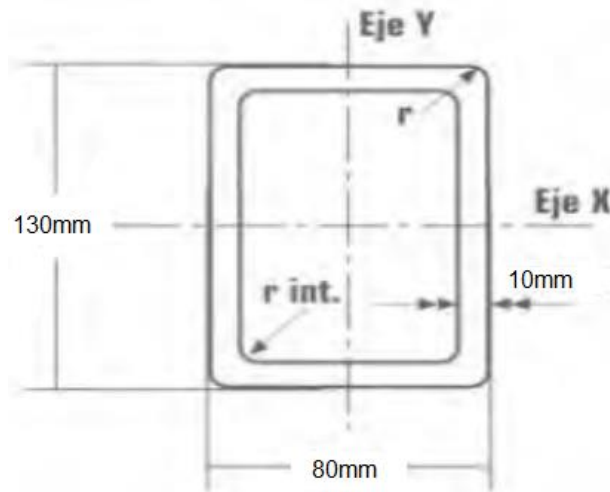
Perfil rectangular. (Fuente Ferrocortes)
